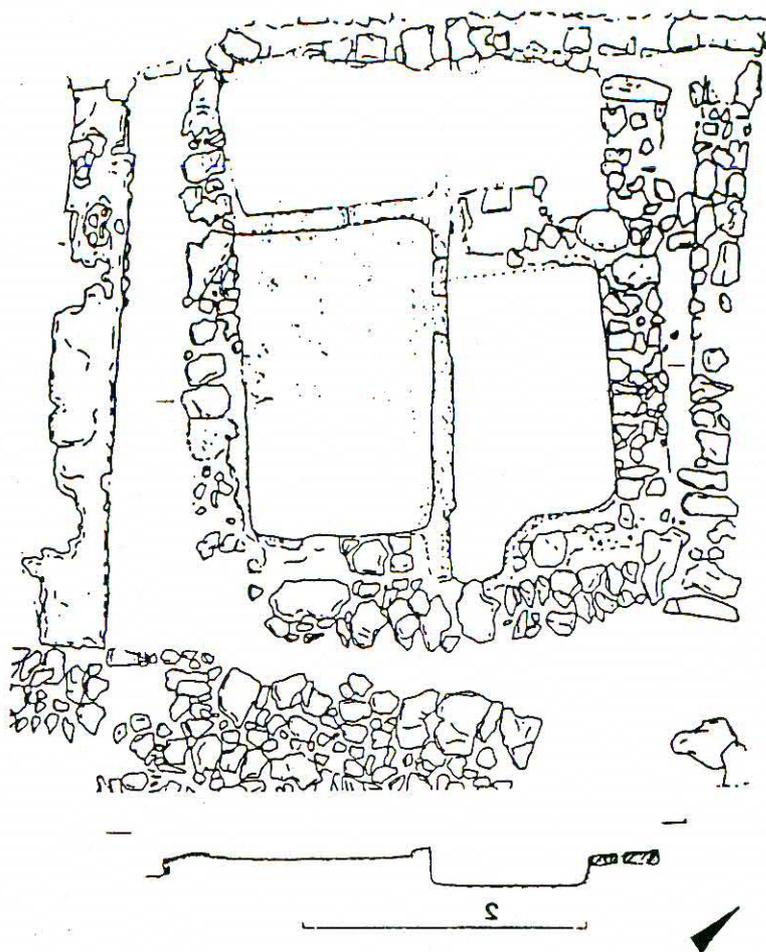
Lagar del departamento 4. Planta y sección. (Plan E. Días).
